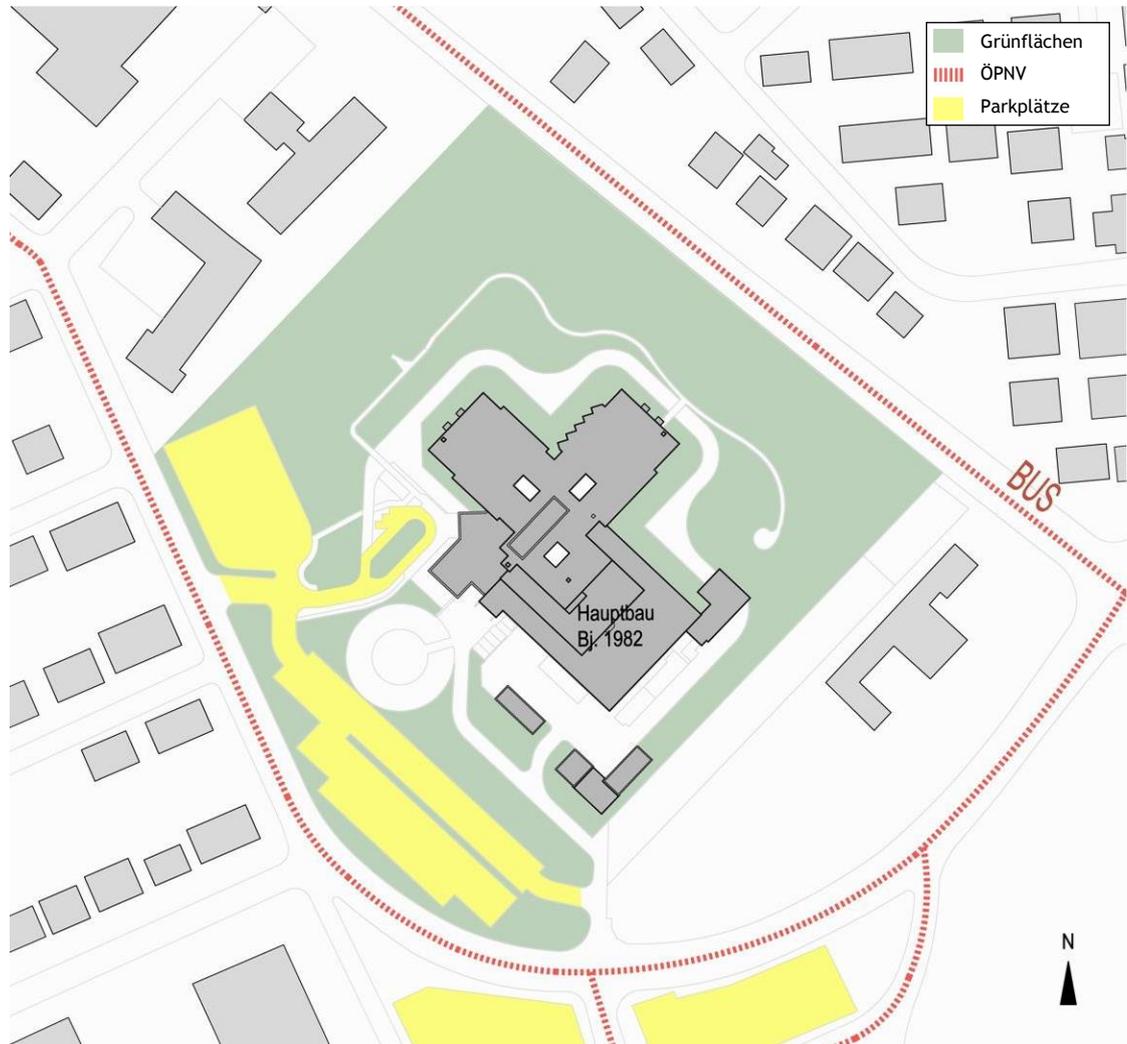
Lageplan mit Grünflächen, ÖPNV und Parkplätzen
